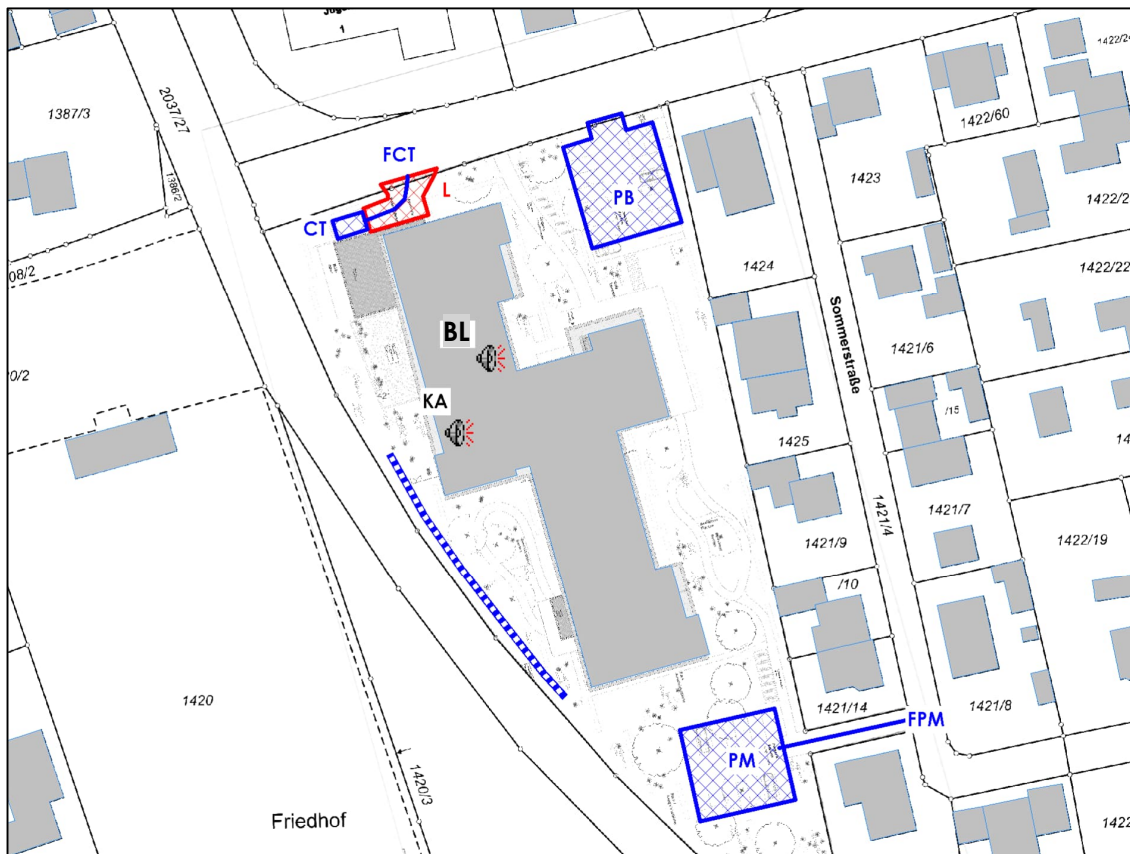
Lageplan mit Darstellung der Schallquellen
